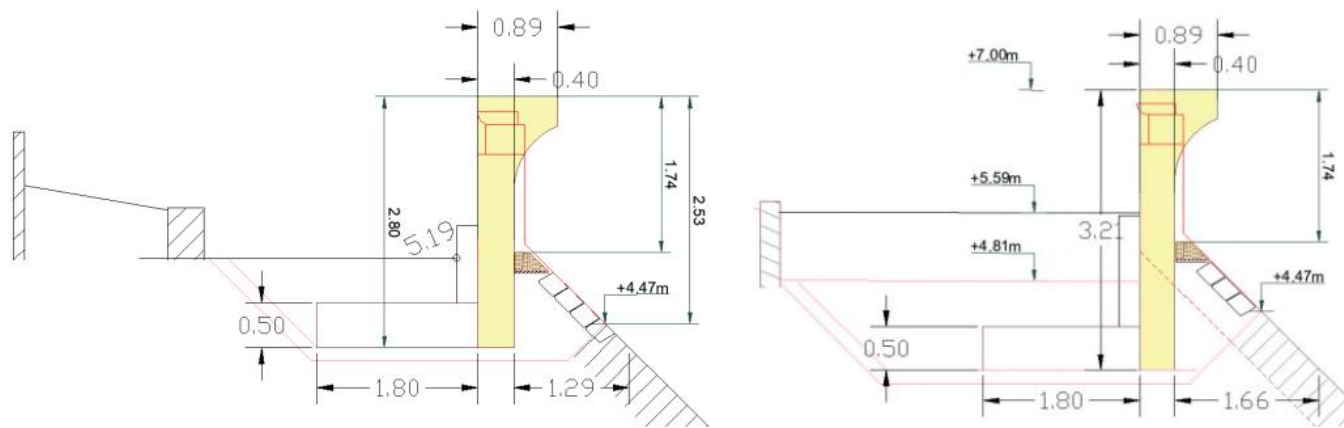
Coupes bas rampe piscine : à gauche Ouest, à droite Est
